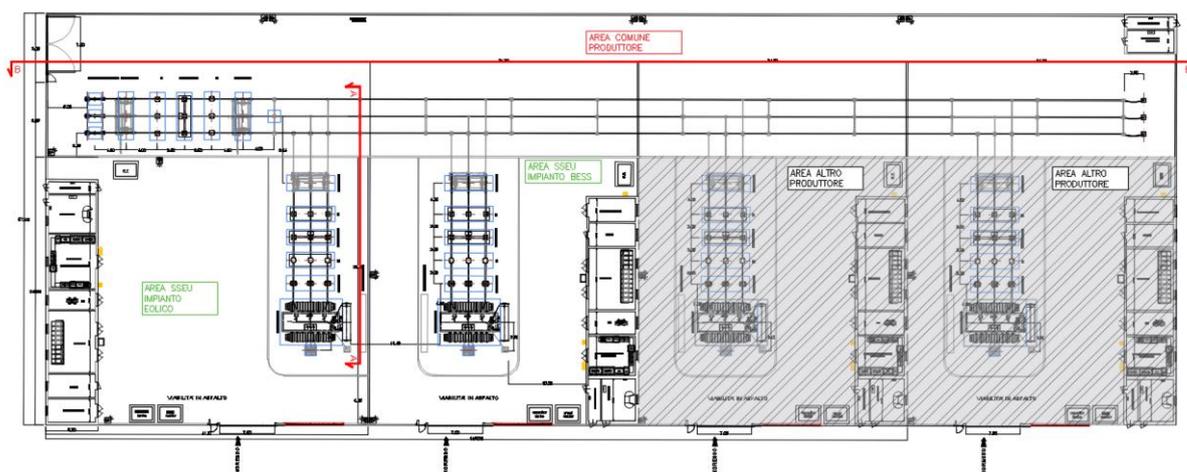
Planimetria elettromeccanica SSE Condivisa
